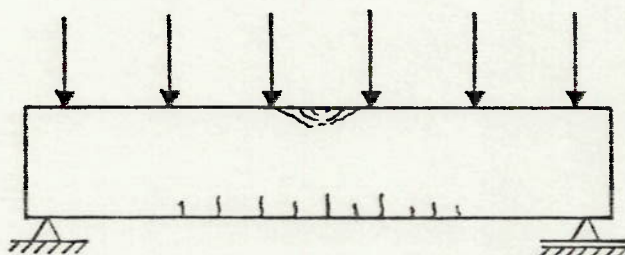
Trincas de compressão em viga super-armada solicitada à flexão
